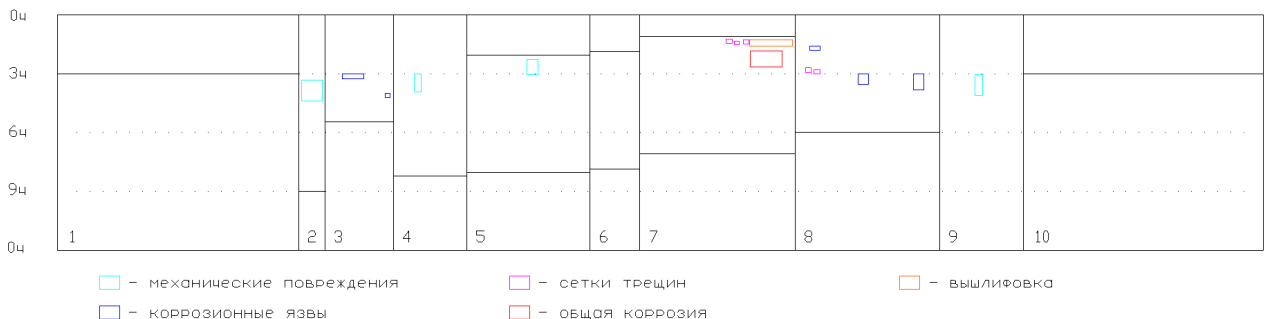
Развертка боковой поверхности испытательного стенда с указанием расположения сварных швов и дефектов
